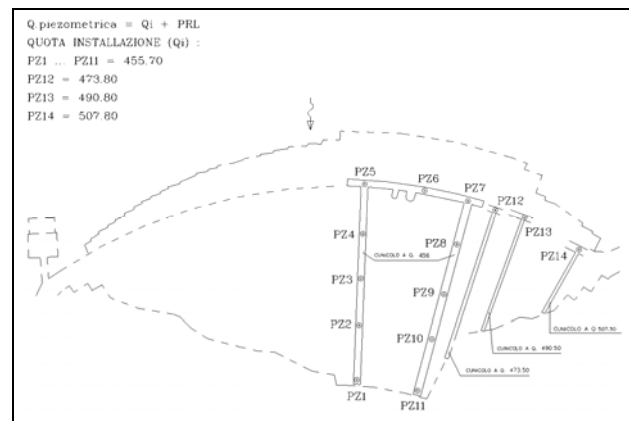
Diga del Salto – Ubicazione planimetrica dei piezometri nei cunicoli in fondazione
